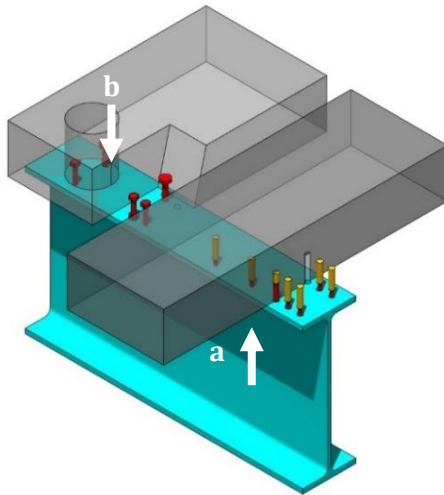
Conexión de tablero a viga metálica accediendo de paramento superior: anclaje post-instalado inferior (a) y por demolición de losa y conector soldado o roscado (b).
